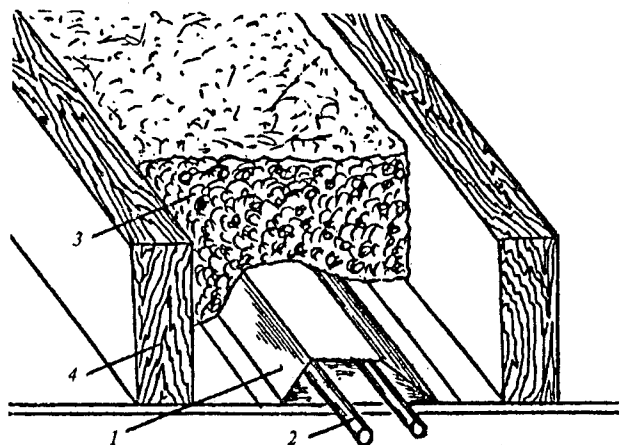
Теплоізоляція водопровідних труб: 1 – брус несучої конструкції; 2 – труба водопровідна; 3 – теплоізоляційний матеріал; 4 – картонна смуга.
